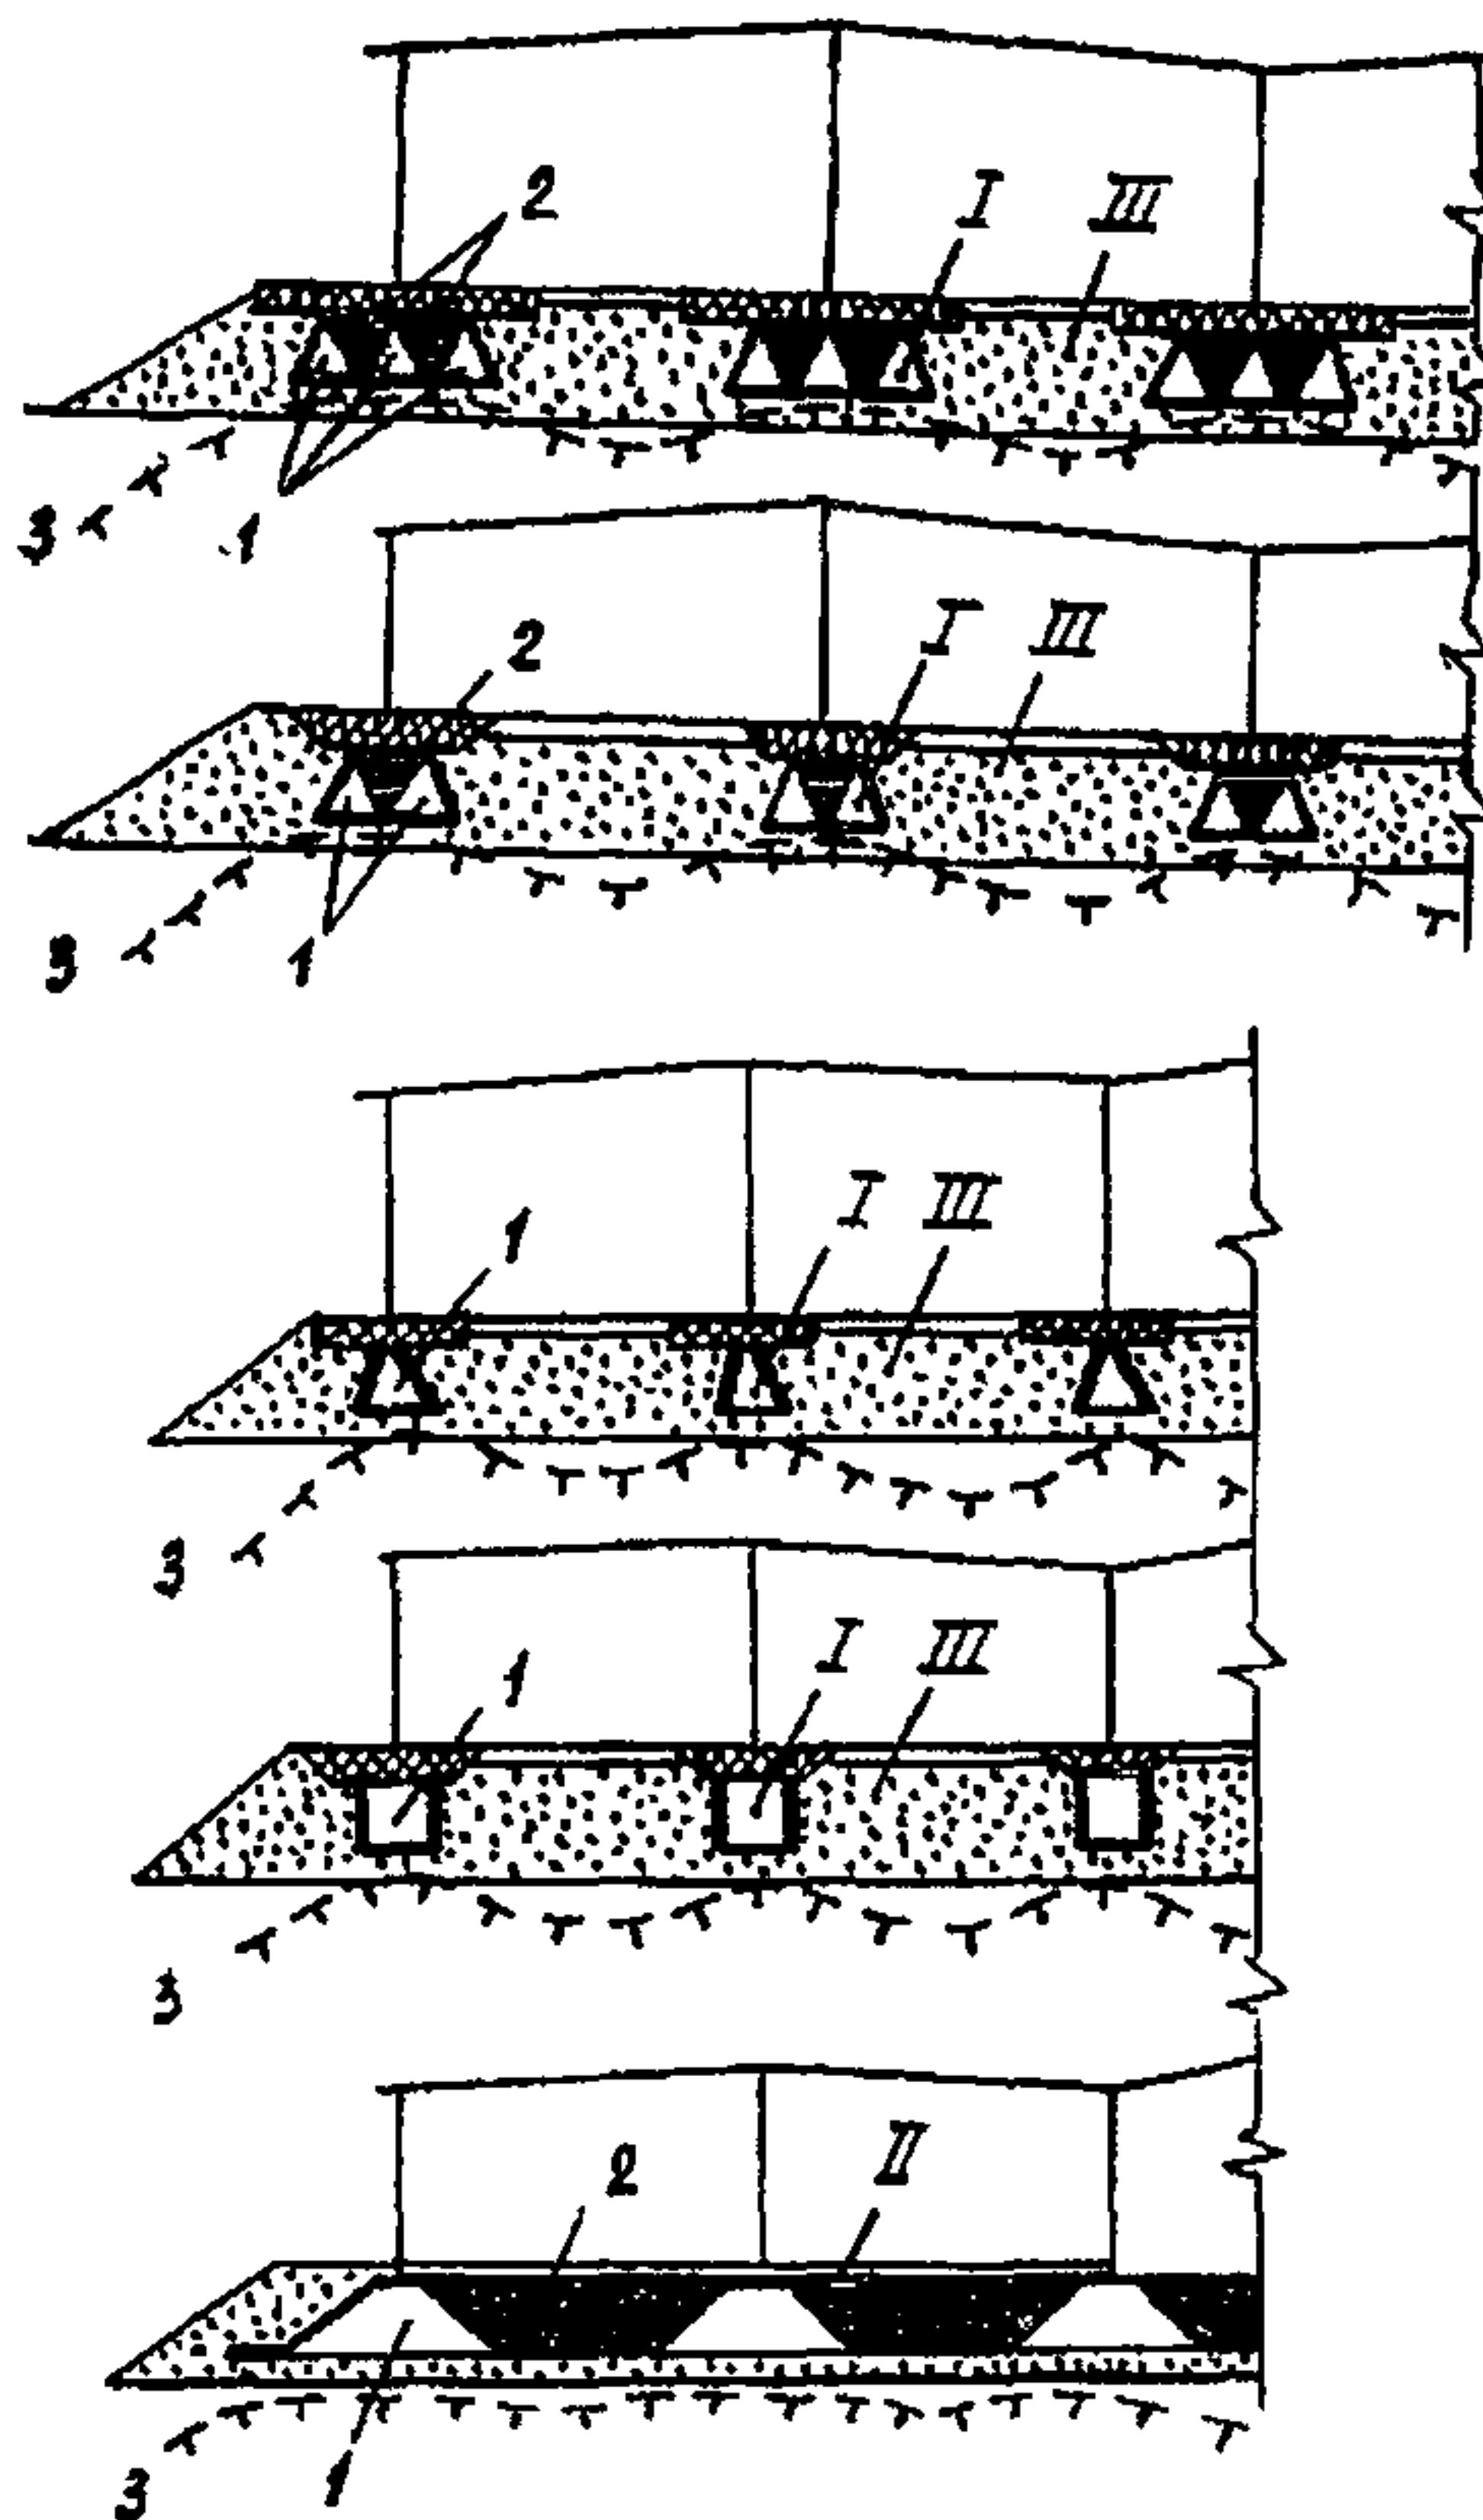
Схемы охлаждения грунтов оснований ленточных и столбчатых фундаментов:
